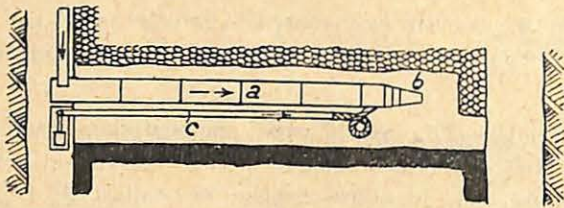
Soufflage du remblai à l'air comprimé par le procédé de Ollrogge.
